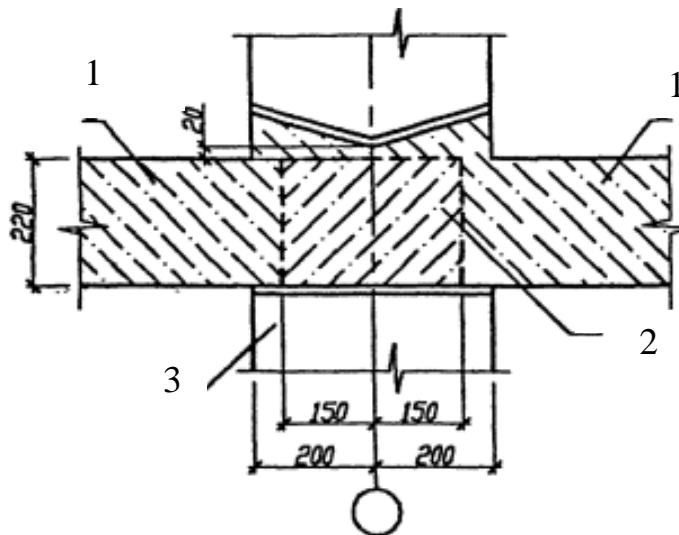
Сопряжение ригелей с колонной: 1 – несущий ригель; 2 – связевой ригель; 3 – колонна
